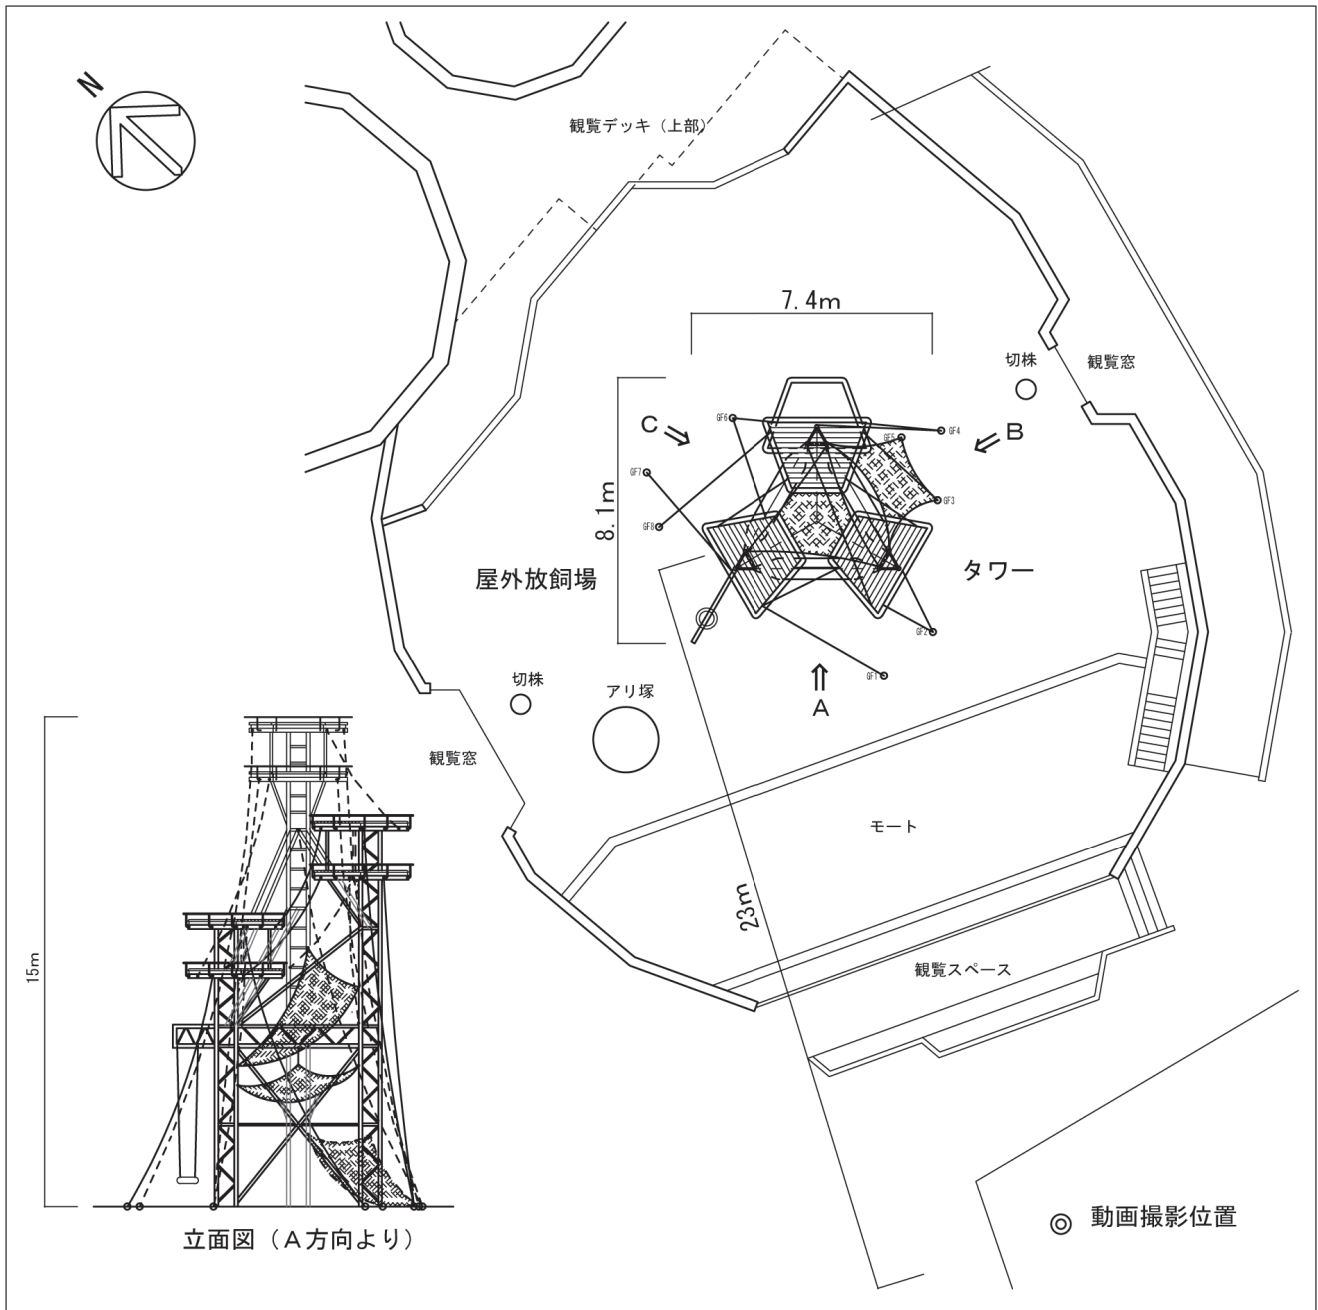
円山動物園チンパンジー屋外放飼場平面図・タワー立面図
